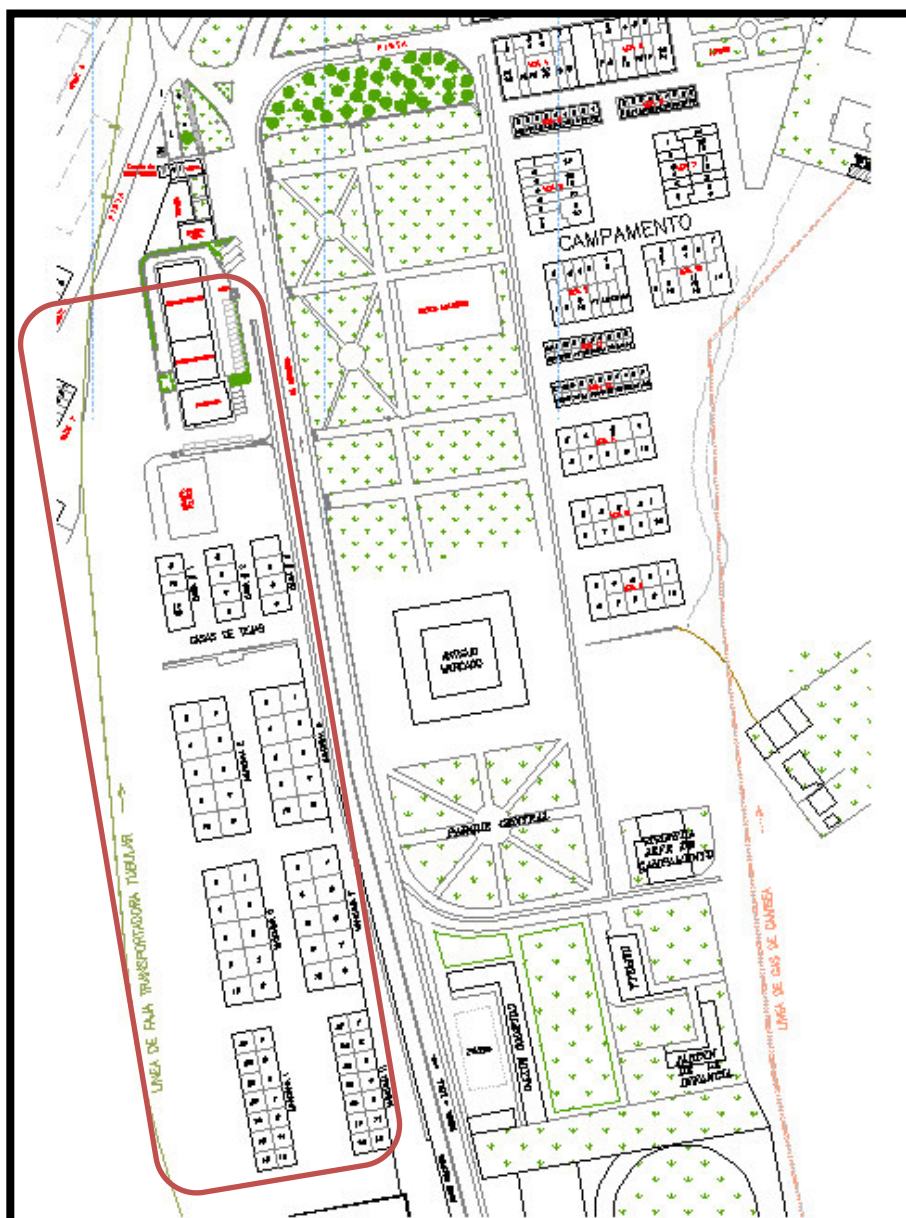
Plan de contingencia – Ubicación de viviendas prefabricadas.
